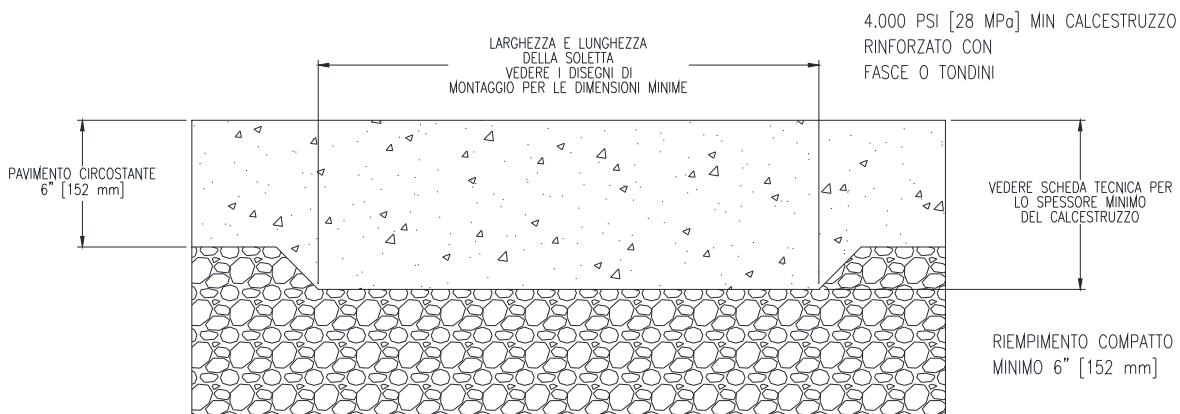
Installazione della lavatrice su pavimento nuovo
